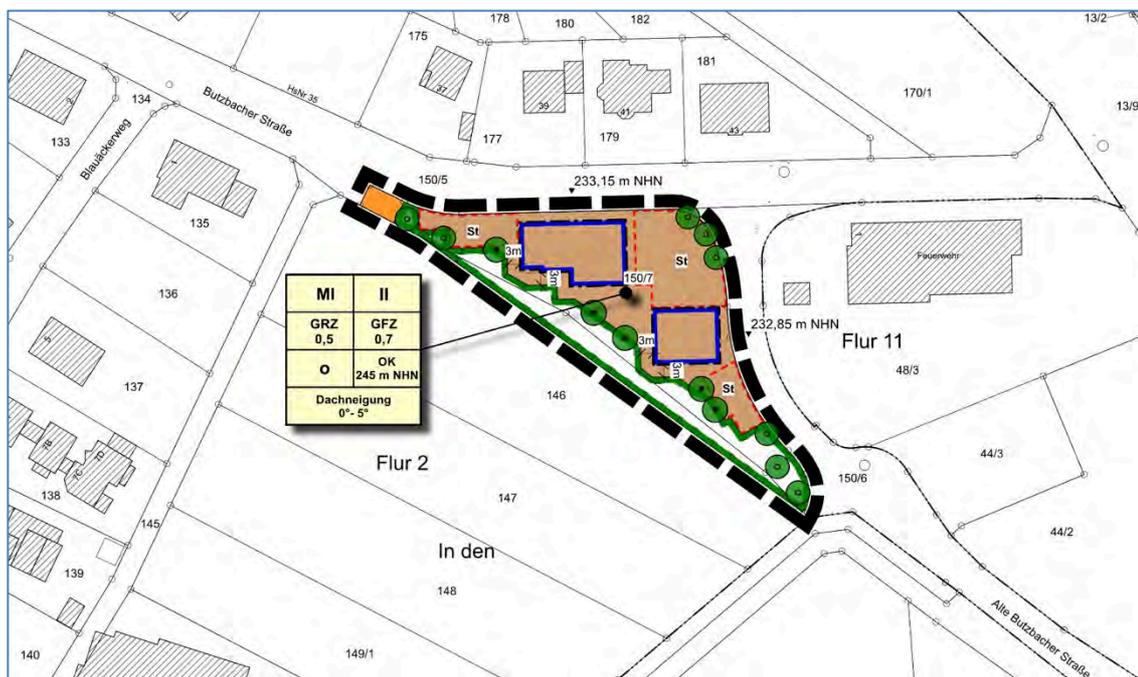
Bebauungsplan „Mischplatz“ - Planteil
